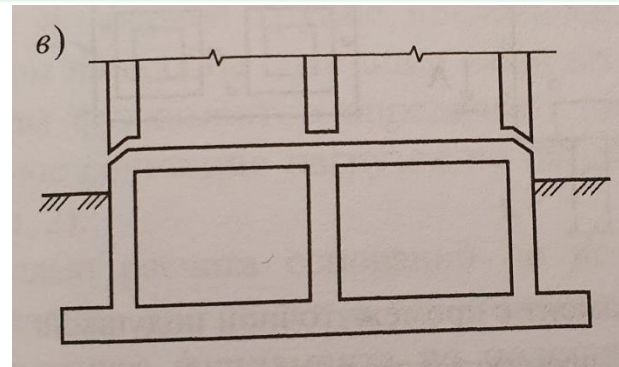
Конструкции фундаментов многоэтажного здания с монолитной подземной частью
